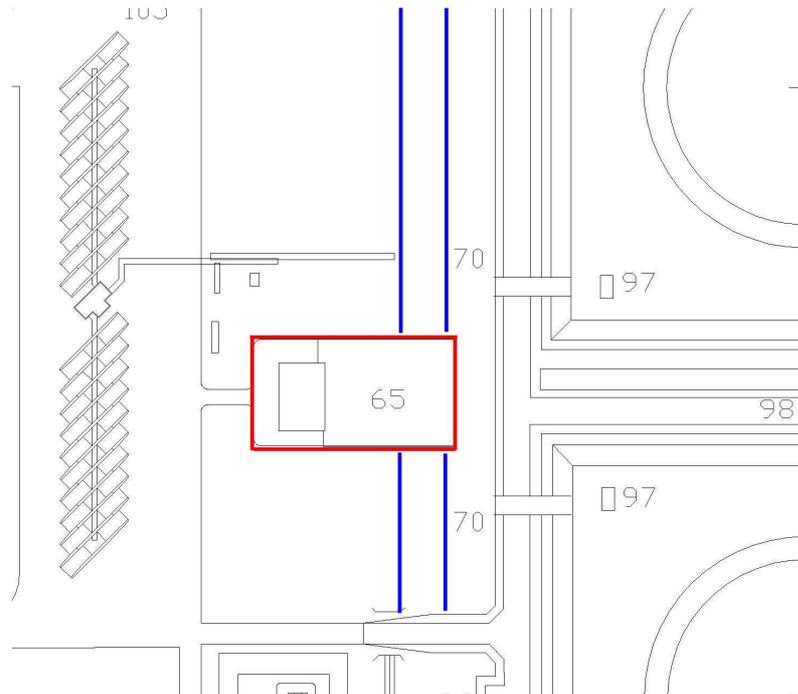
Estratto della planimetria della centrale: cabina pompe spinta sud (in rosso) e relativo fascio tubiero (in blu)
